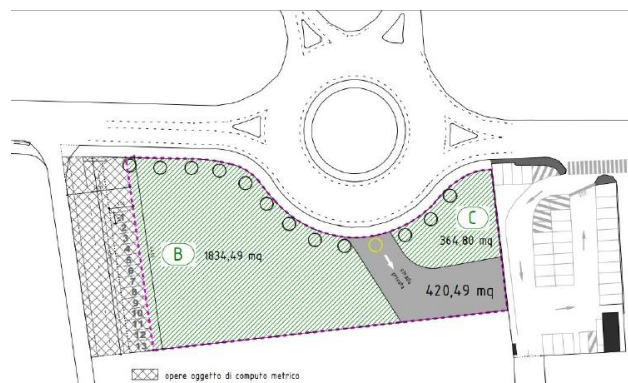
Estratto Elaborato 2 - planimetria di Progetto e superfici drenanti
